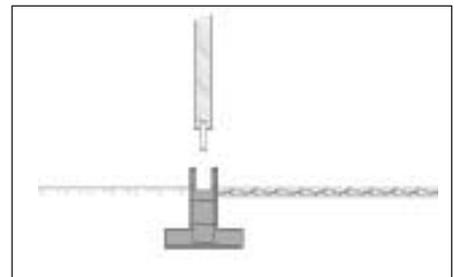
Einzelfundament bestehend aus einer Betonsohle und -säule. In der Säule lässt man eine Aussparung zur Verankerung der Binderstütze aus Holz. Nach Montage und Ausrichtung der Binder wird die Öffnung mit Beton ausgegossen.
